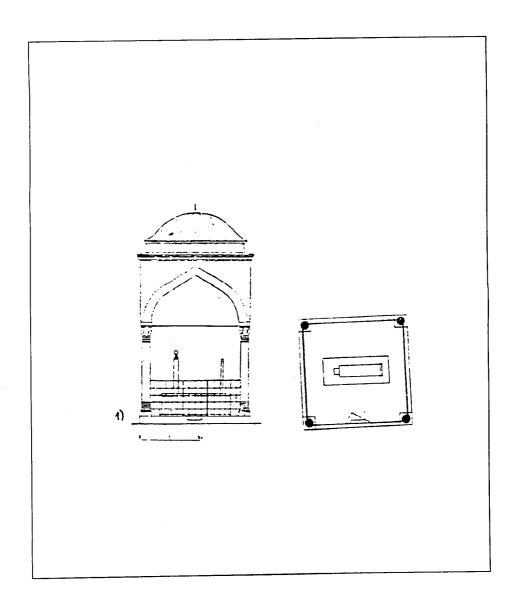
مسقط أفقي لتربة KidemLi Baba في نوفازاجورا ببلغاريا (عن : كيل) .
